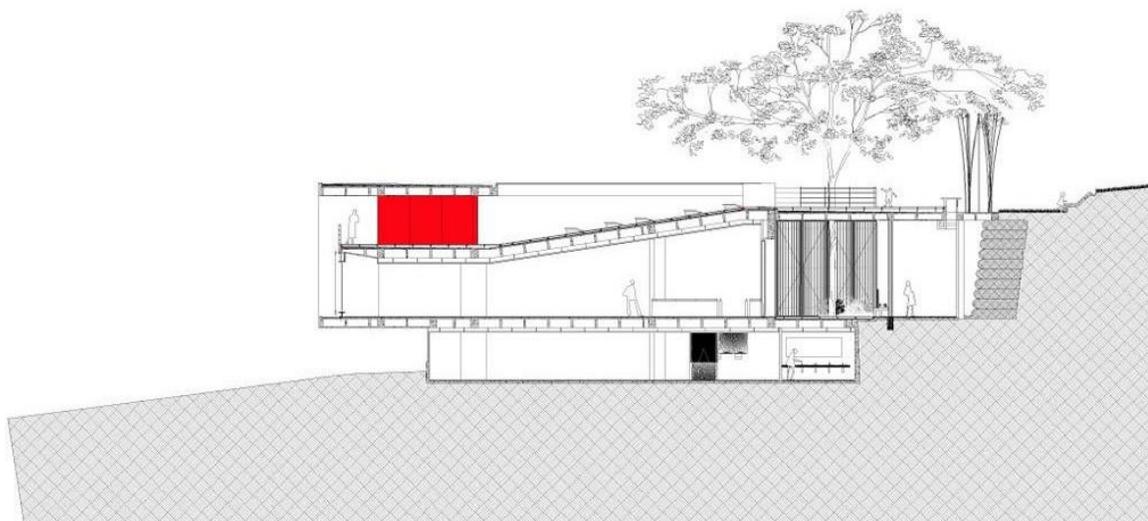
Corte longitudinal da Biblioteca Parque León de Grief, 2007. Autor: Mazzanti. Fonte: Archdaily.
